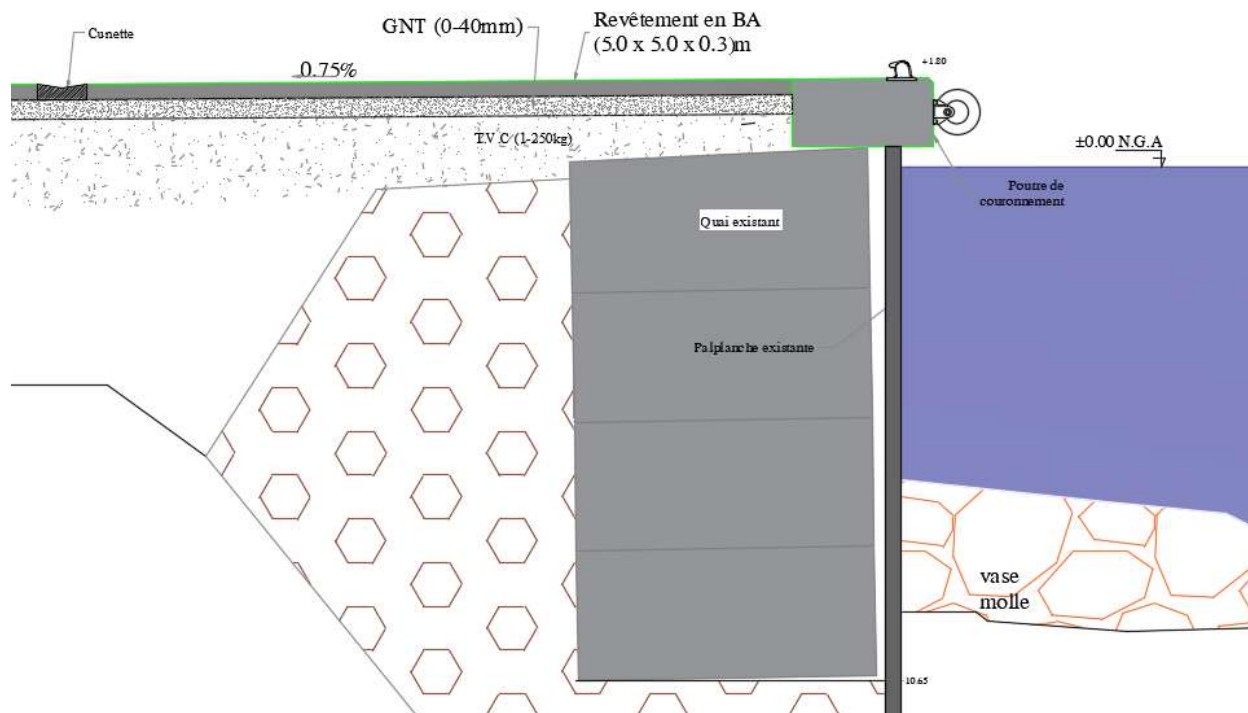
Coupe transversale du profil type du Quai de la Passe
